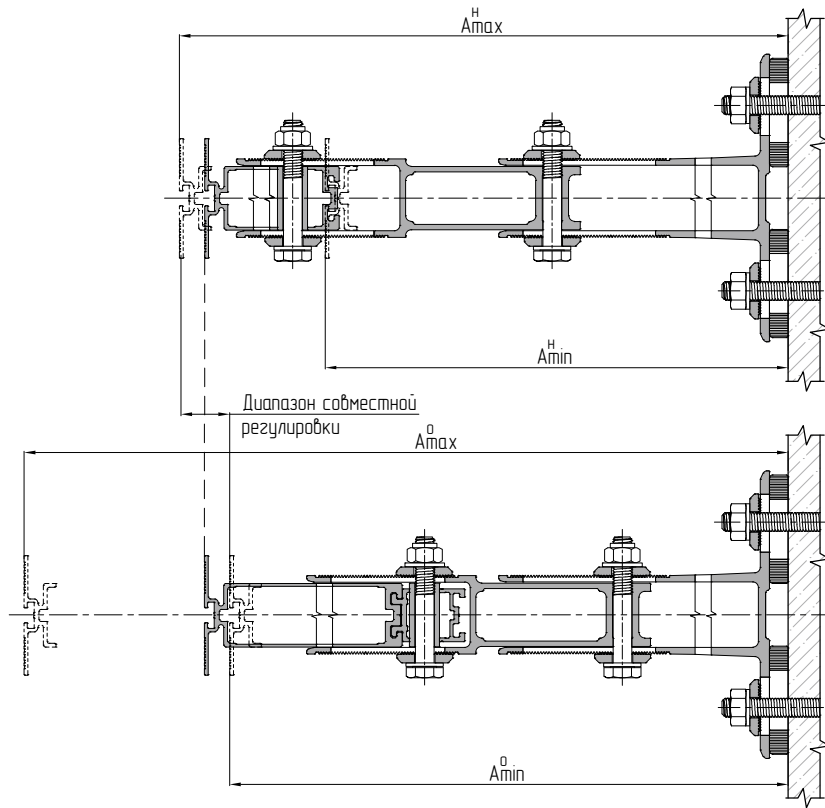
Рисунок VI – для схем сопряжения 6 и 14, схем 8 и 14, схем 8 и 16, схем 14 и 22, схем 16 и 22, схем 16 и 24
